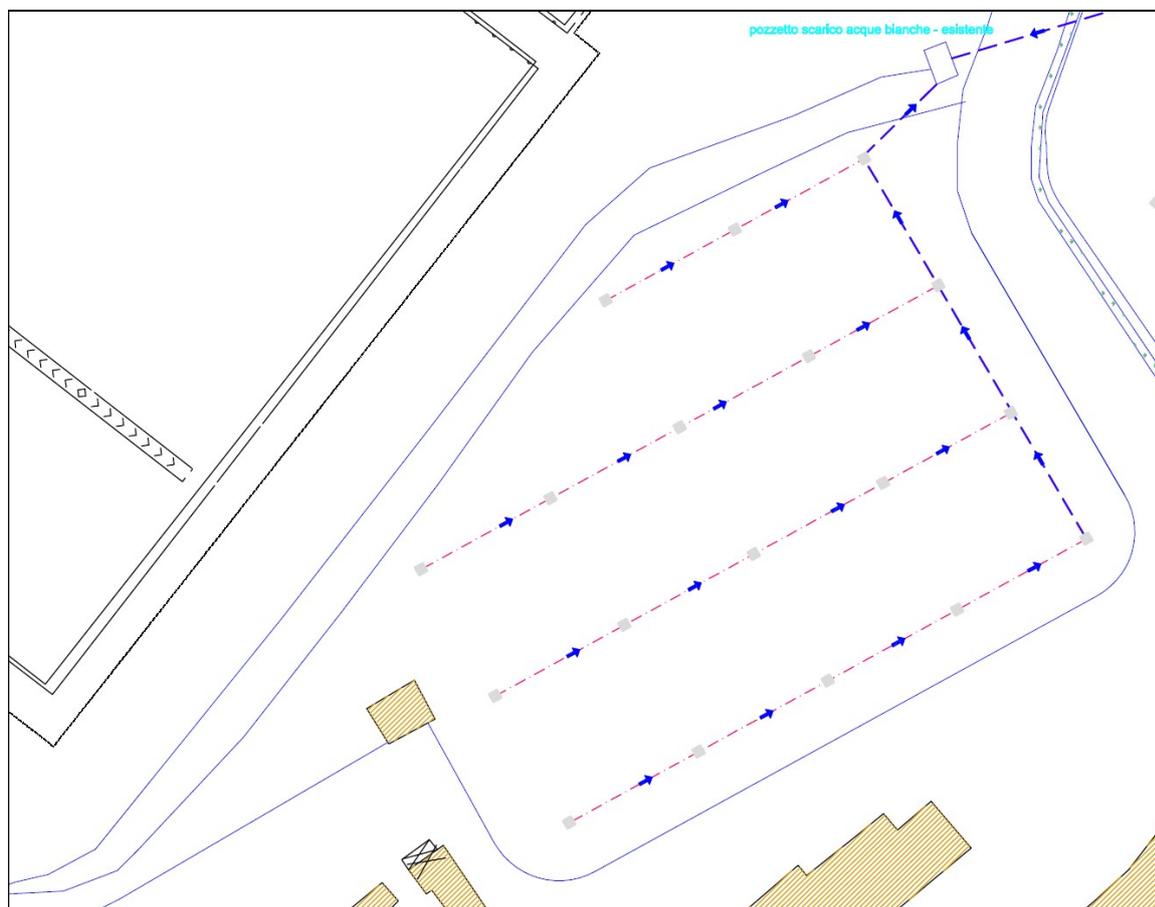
Planimetria dell'area barche con la rappresentazione delle opere in progetto
